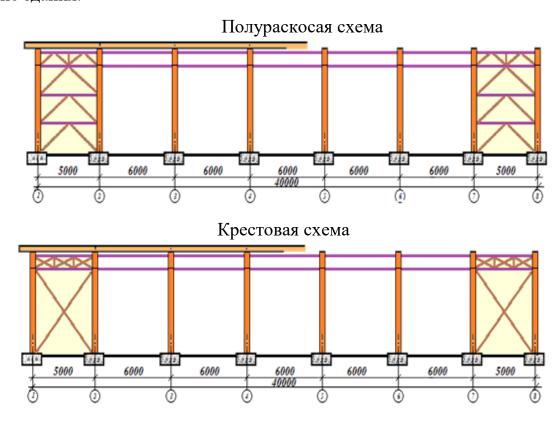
Схемы и узлы вертикальных связей между а) колоннами б) фермами
